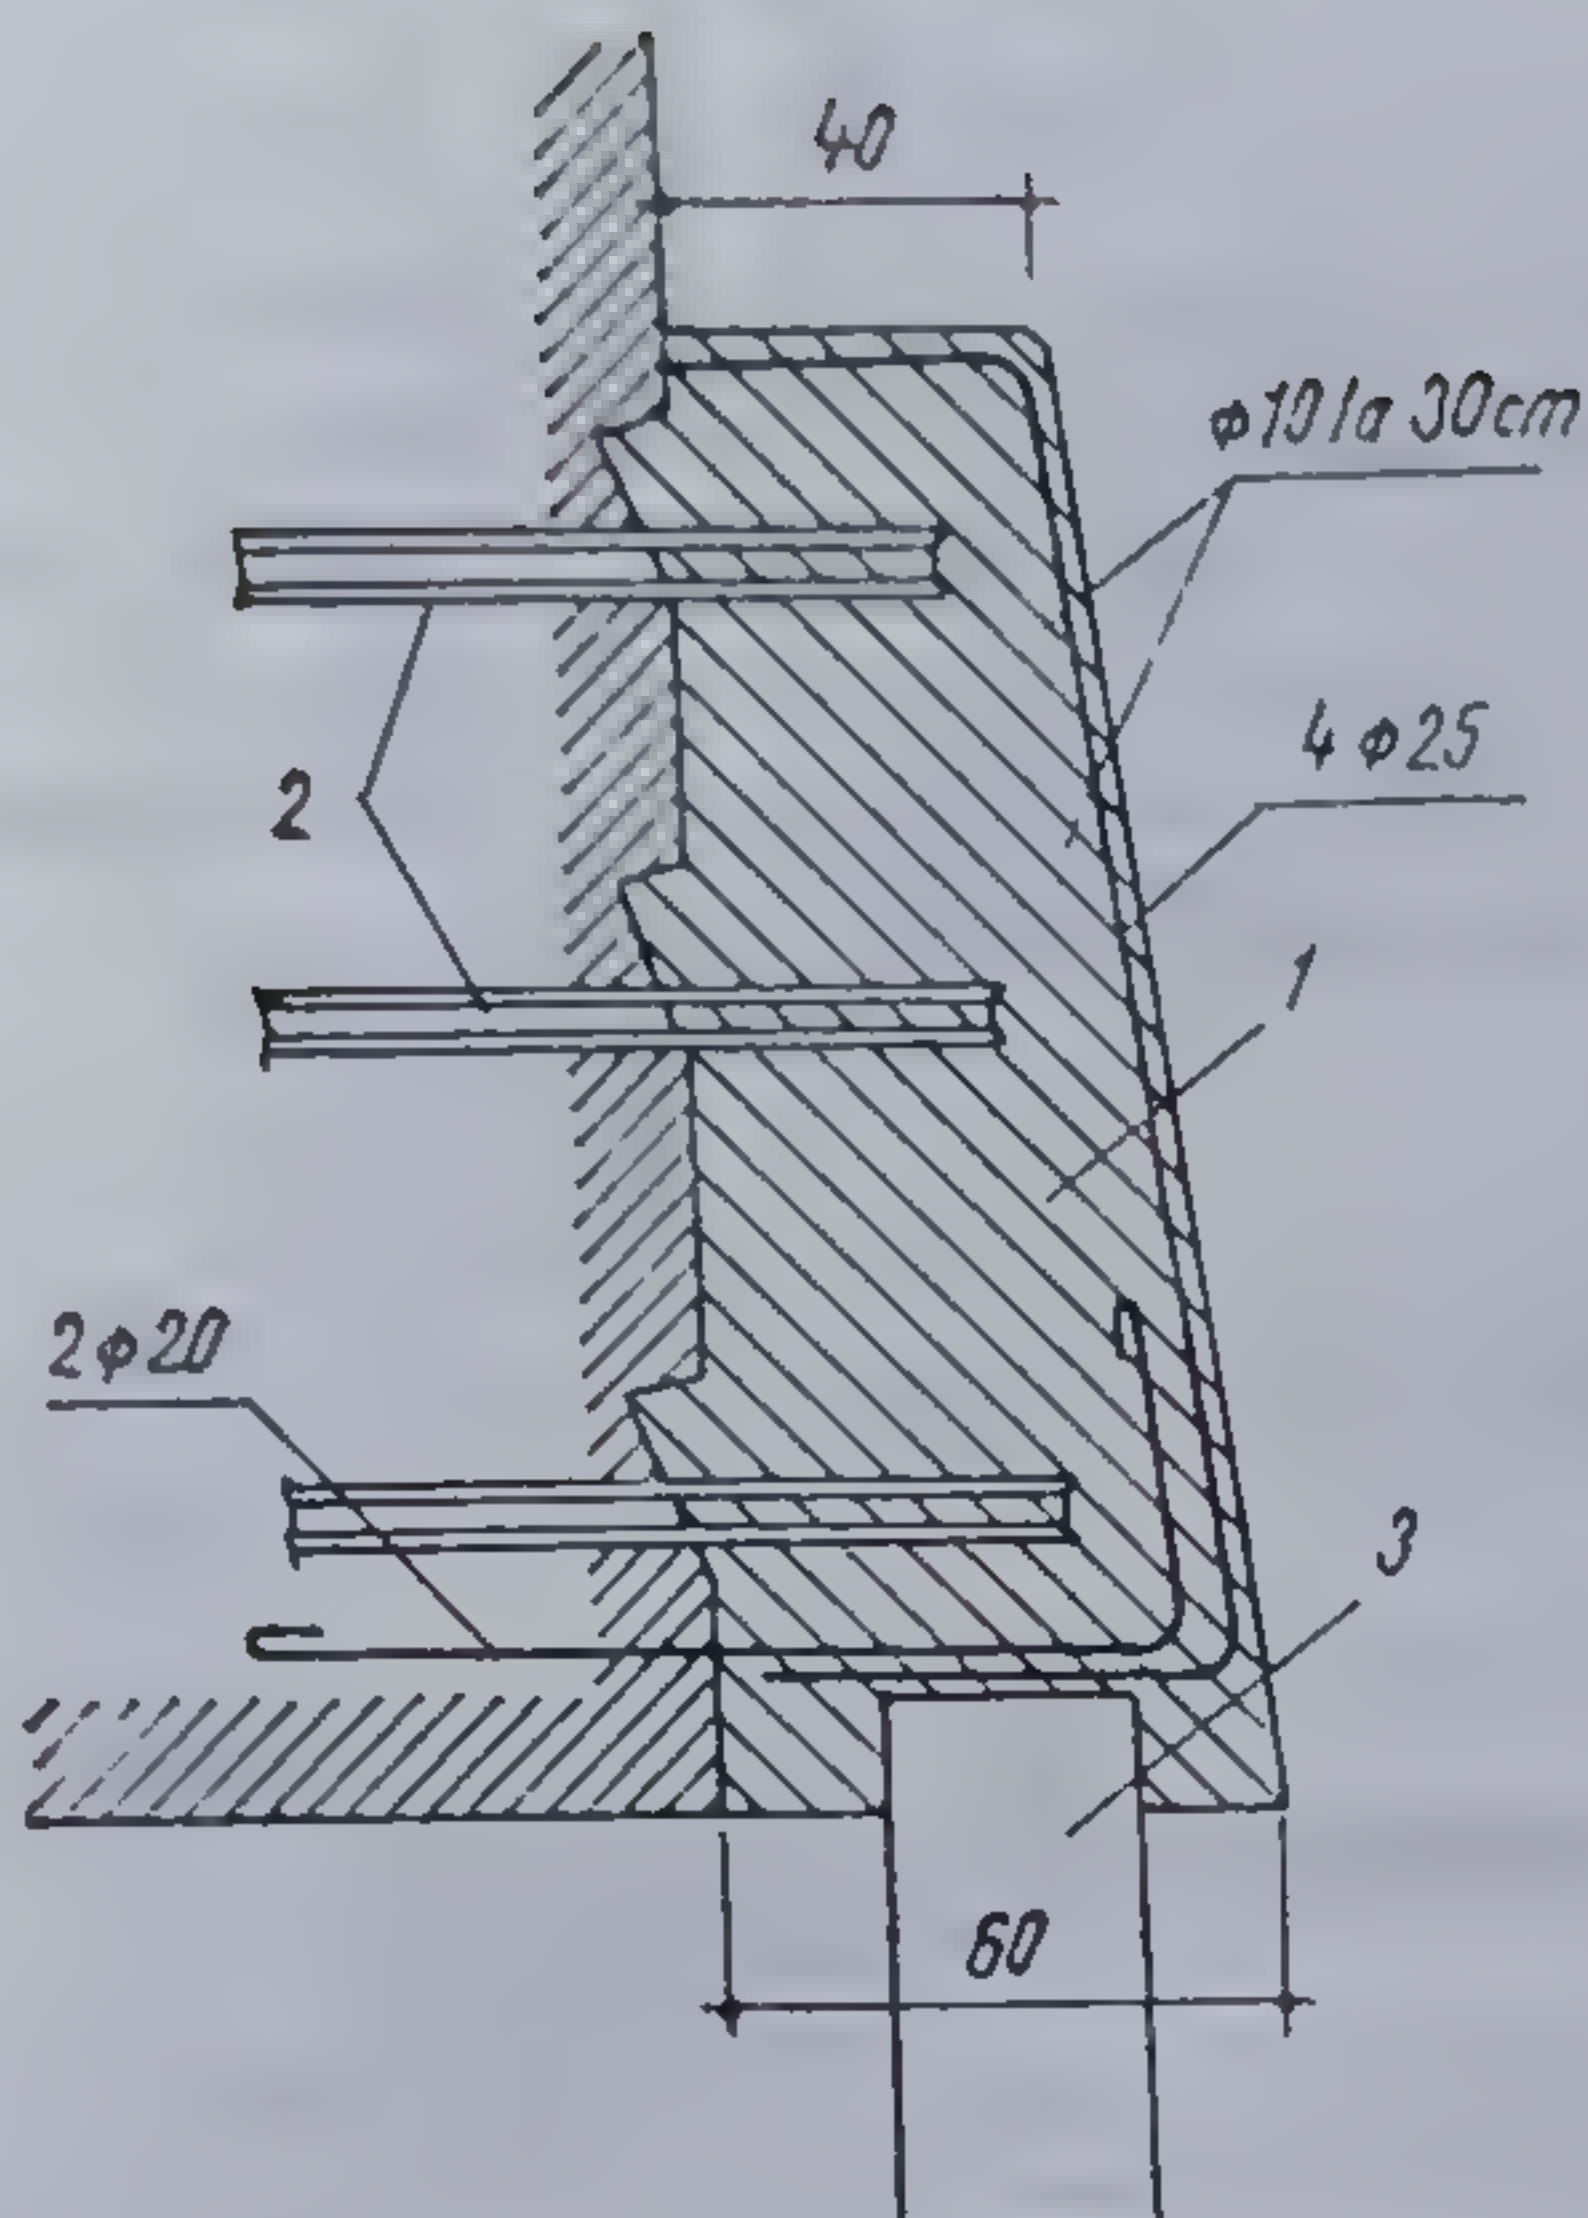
Exemplu de consolidare cu pînten din beton armat și piloți forăți :
